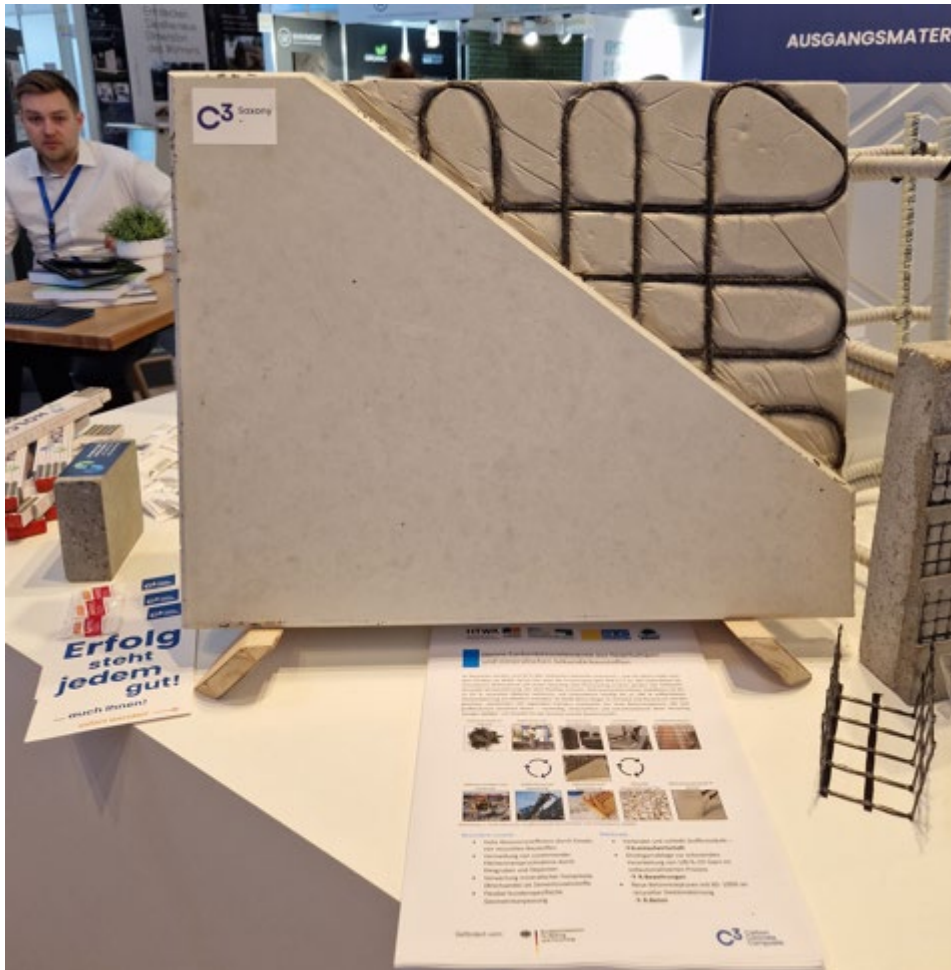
Ausstellung des Demonstrators Fassadenelement mit 60% Betonrezyklat und R-Carbonbewehrungsmatte auf der BAUMA 2025 in München
